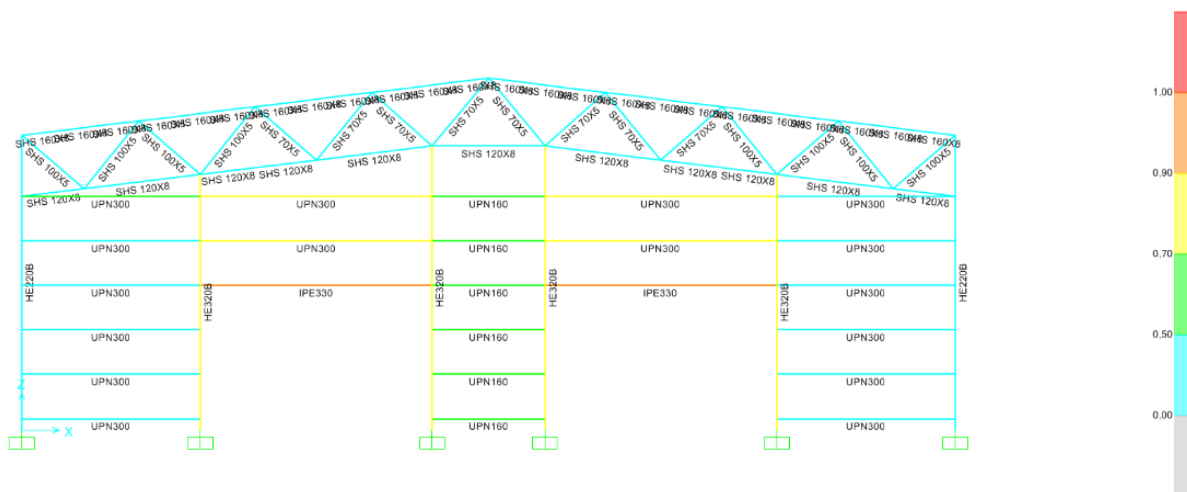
aprovechamientos pórtico fachada 1 ($y=0$)
